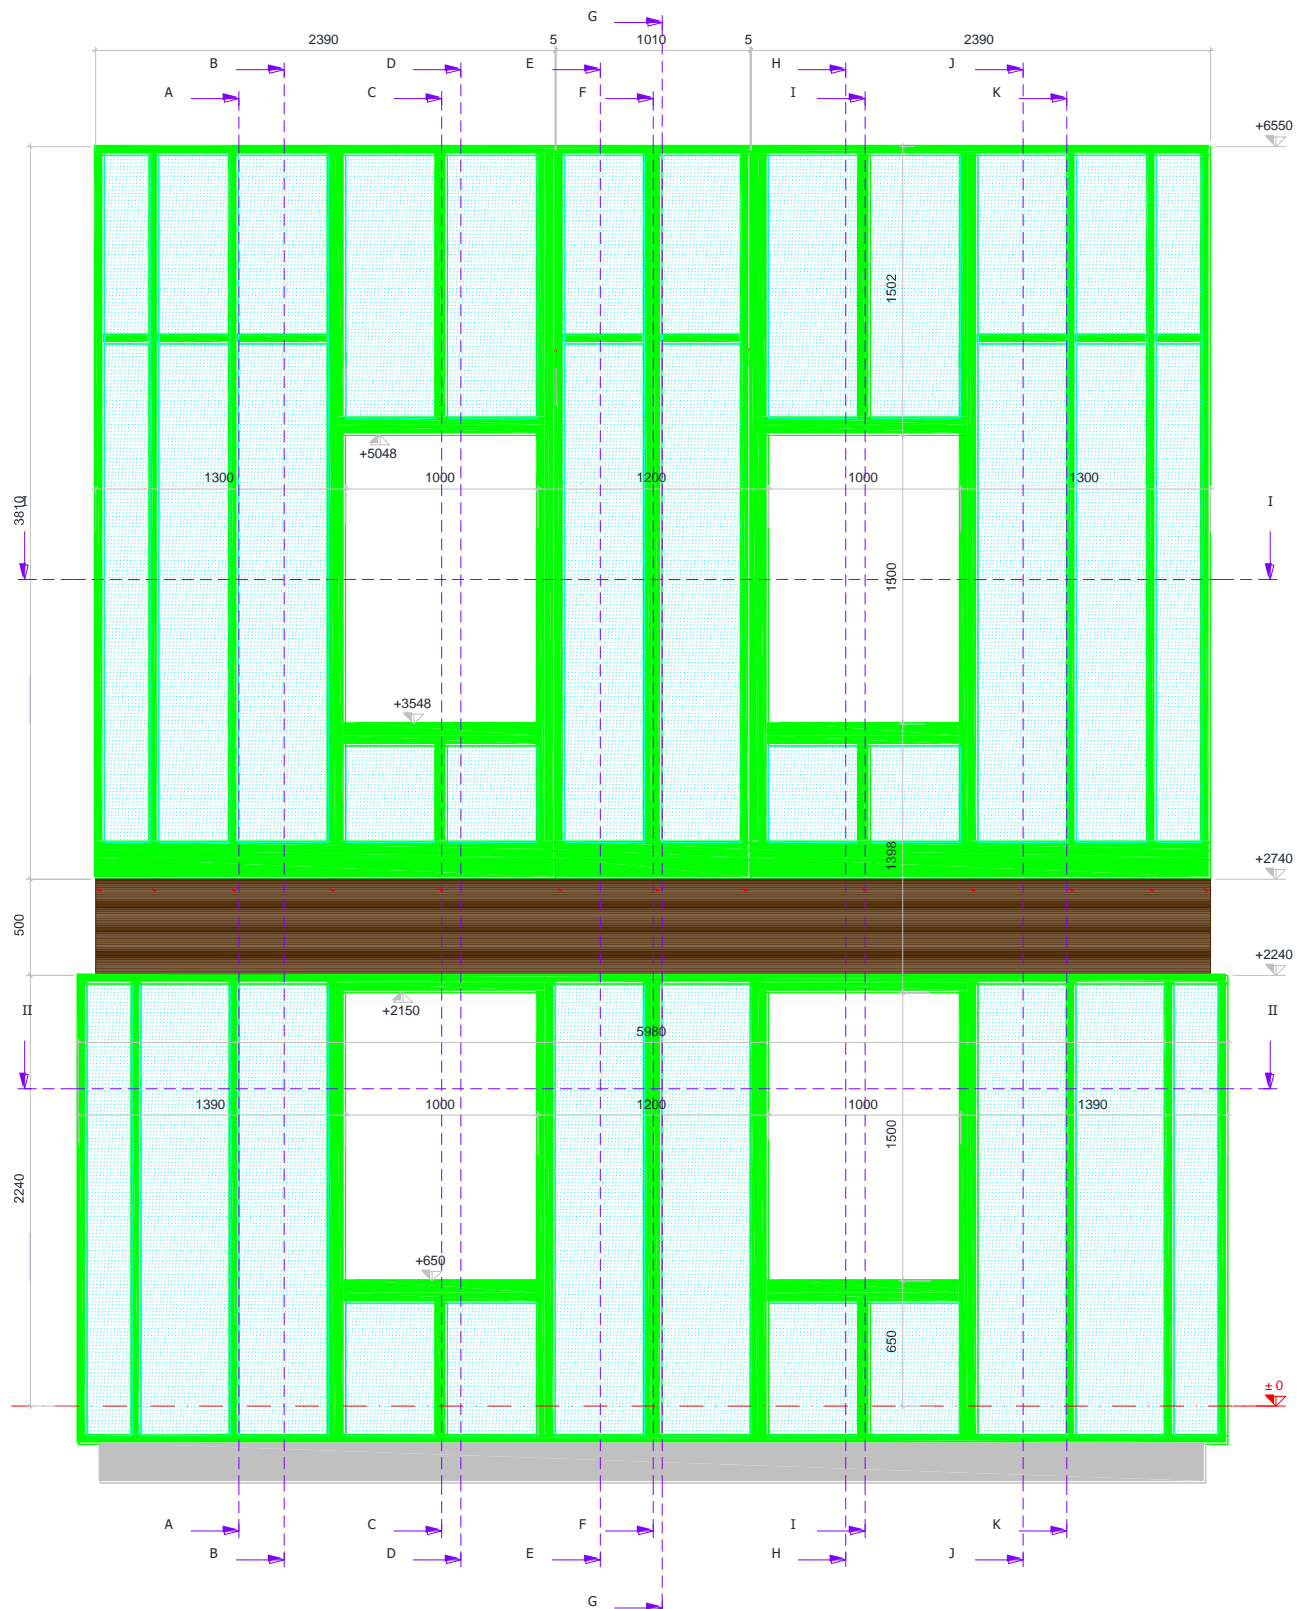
Instrumentation de l'élément de façade - Vue des coupes sur l'élévation d'ossature
